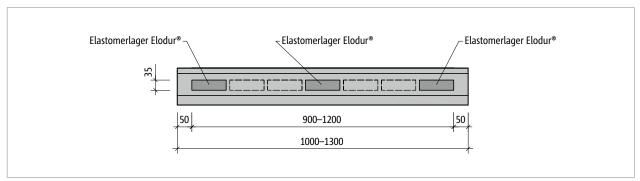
Schöck Tronsole® BL, BZ: Grundriss, beispielhafte Darstellung Tragstufe V1, Länge 1000–1300 mm
